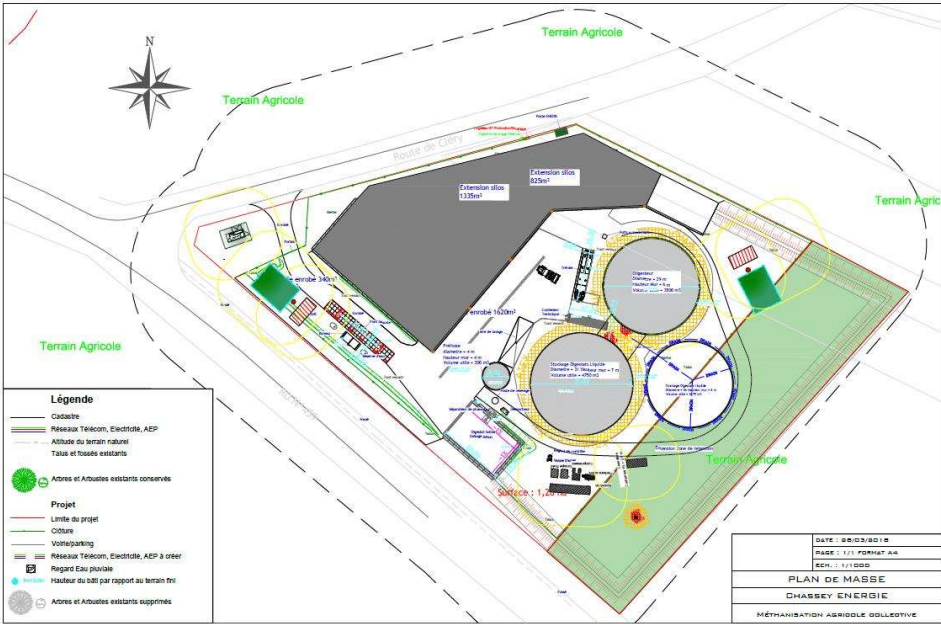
PLAN DE PRE-IMPLANTATION
